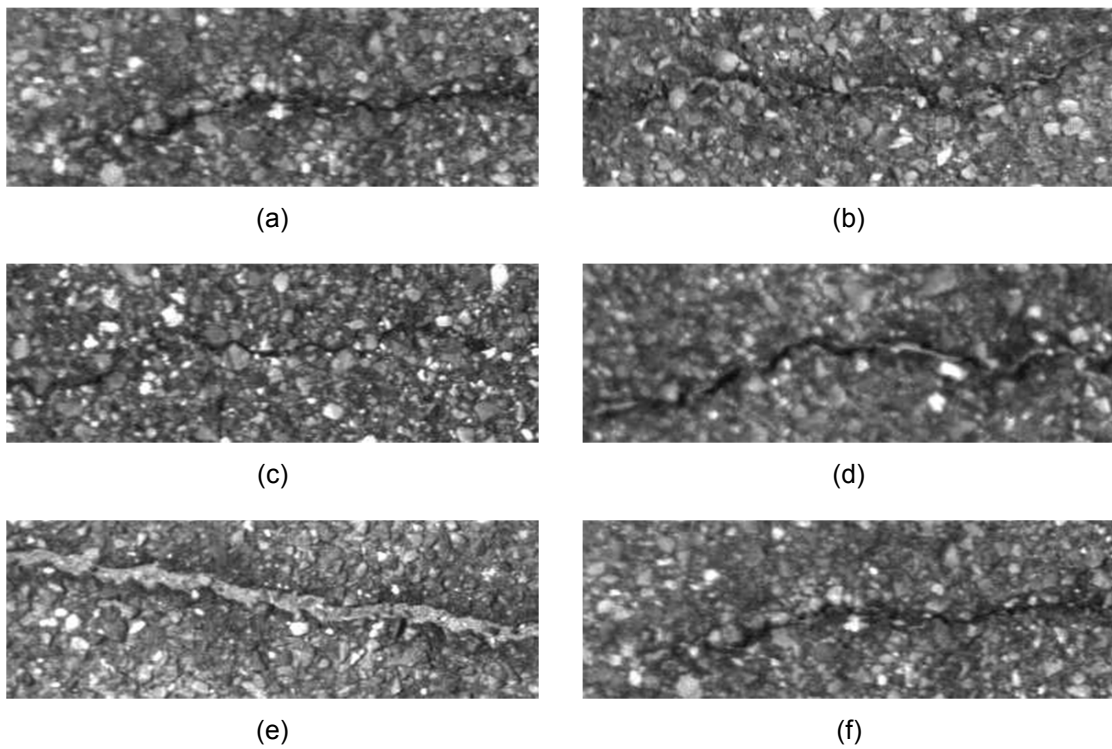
Imágenes de grietas transversales utilizadas en el entrenamiento
